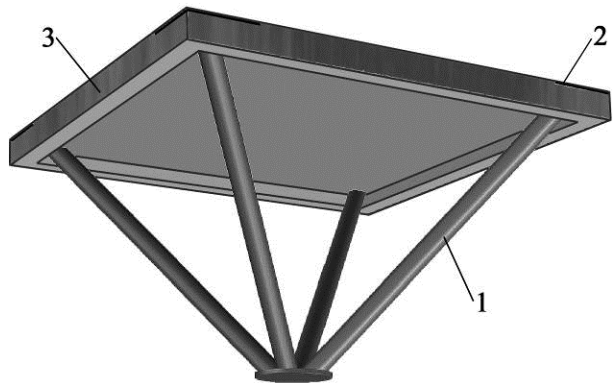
Модульний елемент сталезалізобетонного структурно-вантового покриття / Unit of steel and concrete composite grid-cable roof:
